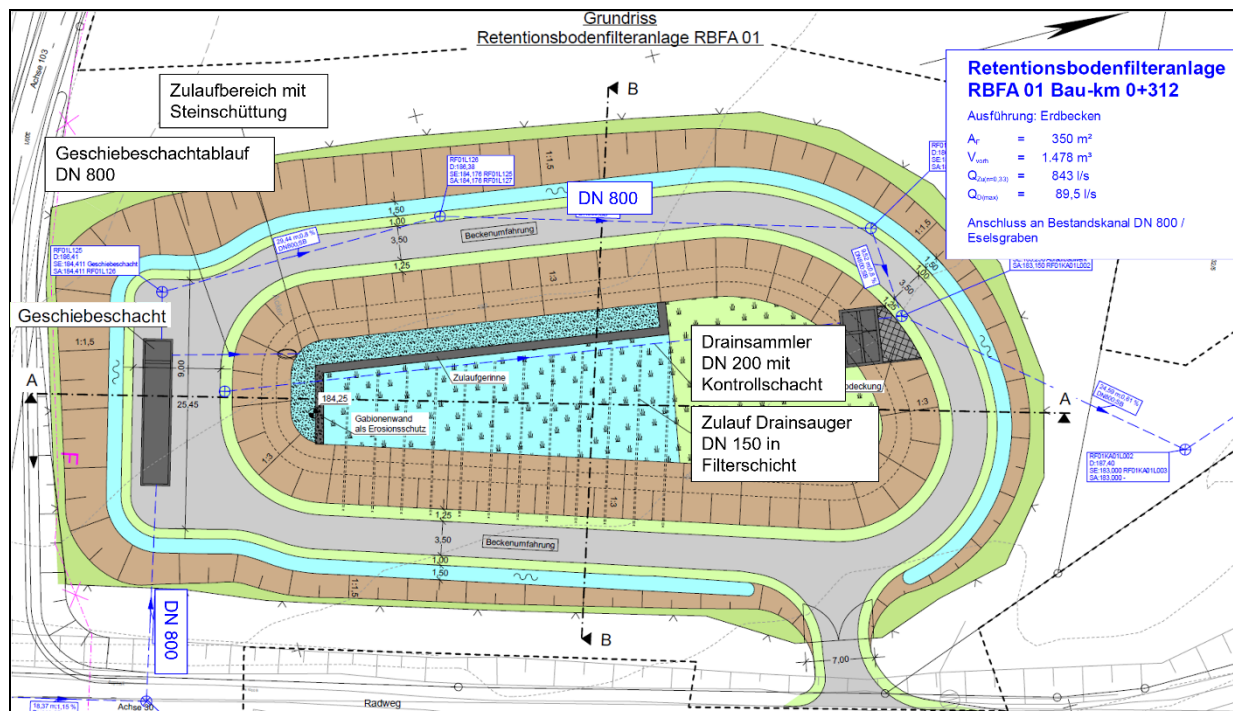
Grundriss der Retentionsbodenfilteranlage 01 (RBFA 01)
